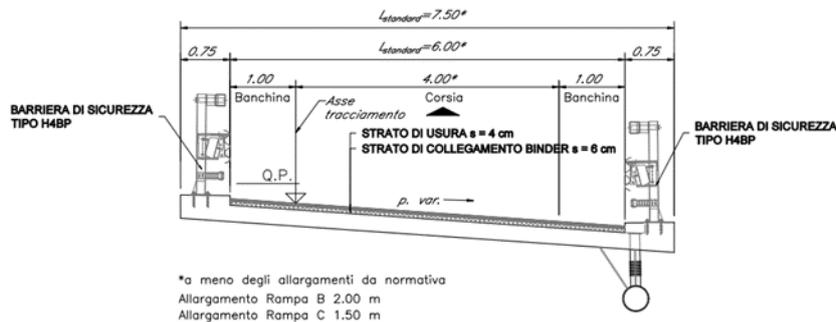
Sezione Tipo Monodirezionale in viadotto
